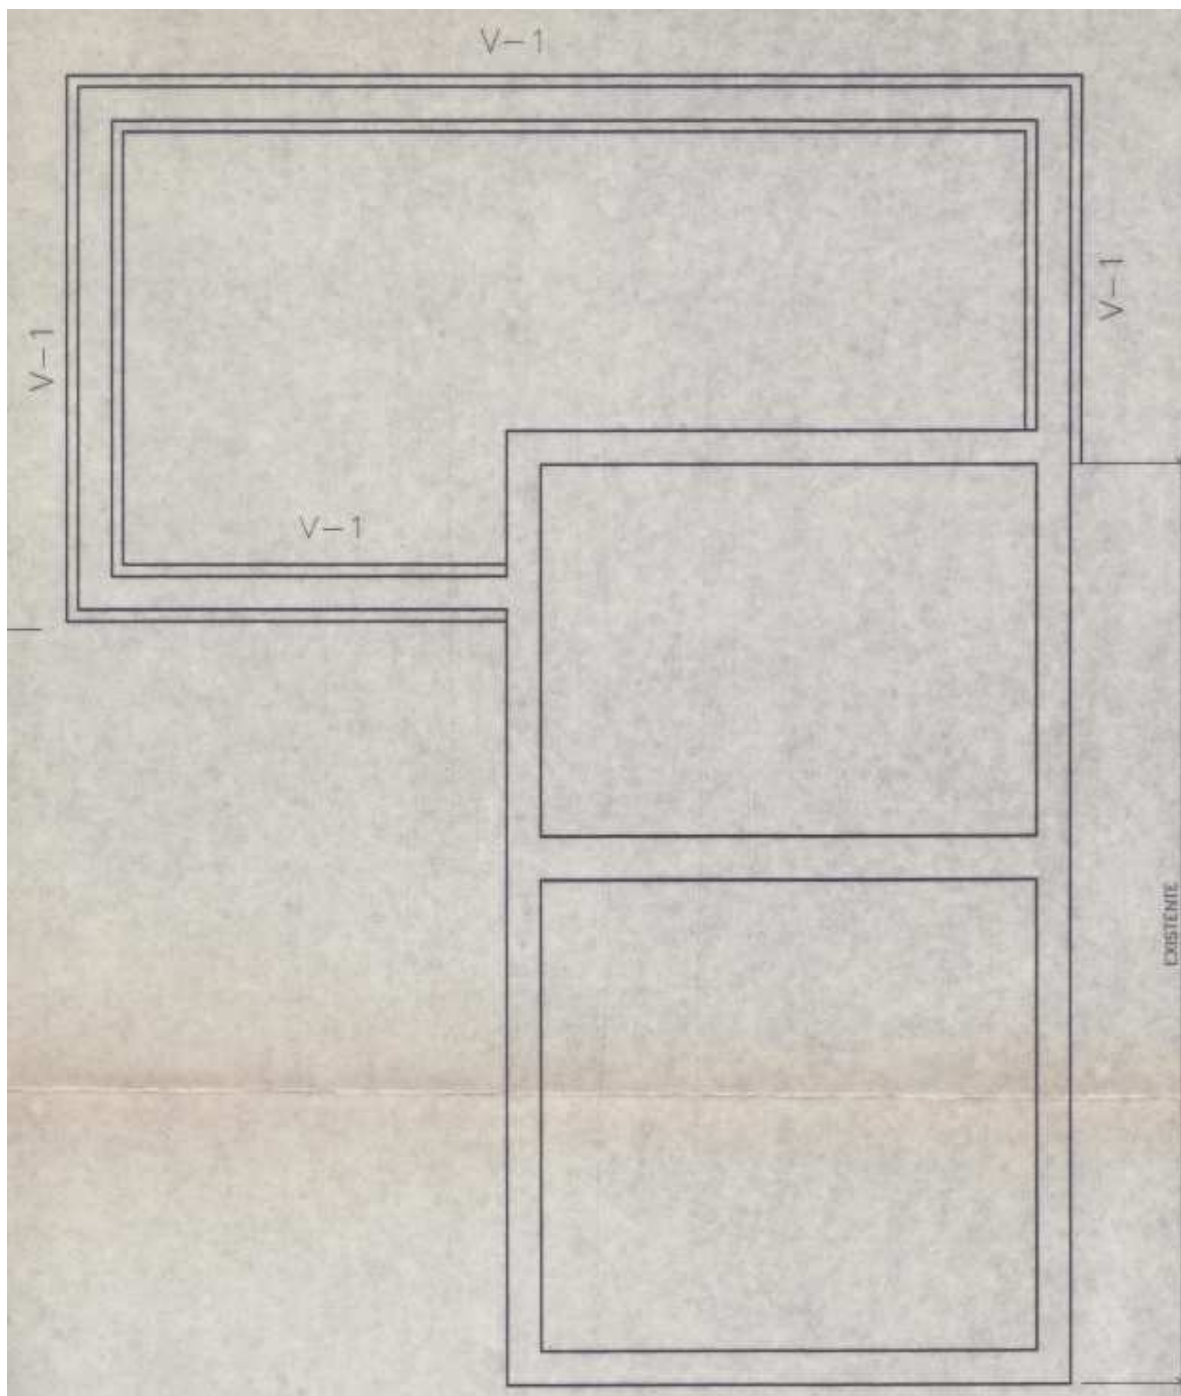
d) Plano nº 5.d): Vivienda unifamiliar rural aislada. Plano de cimentación
